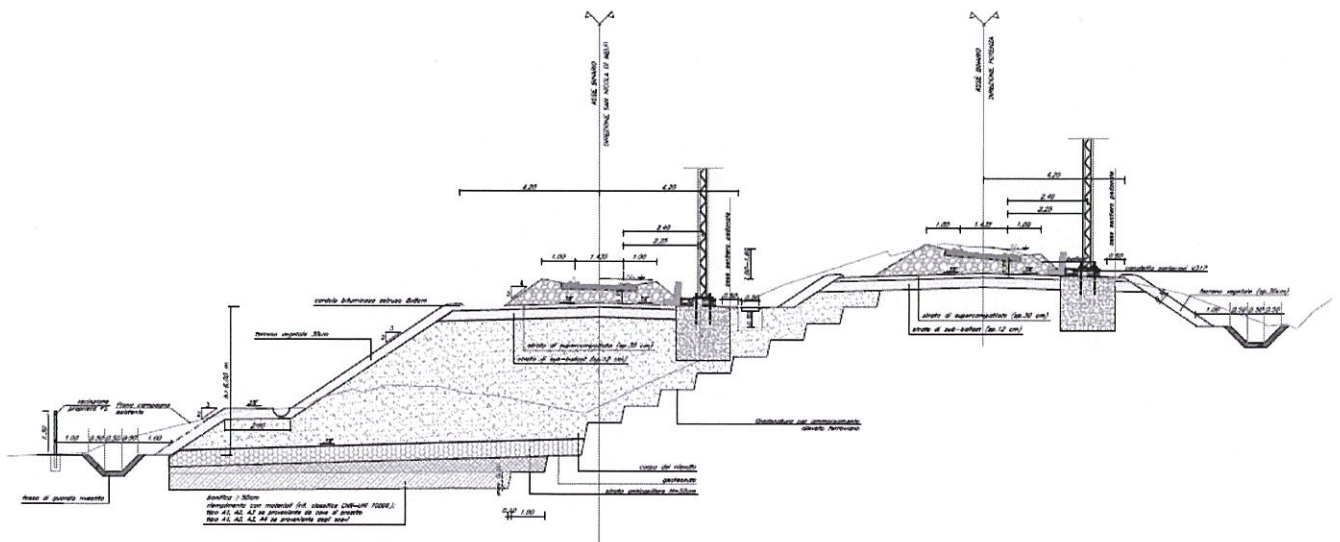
Variante di Rocchetta - Sezione tipo a singolo binario
